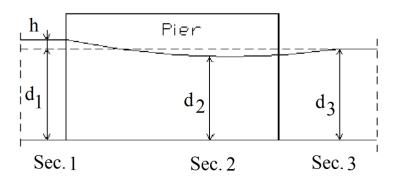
مجرى معتَرَض مختَنِق بالركائز الوسطى والجانبية معاً
